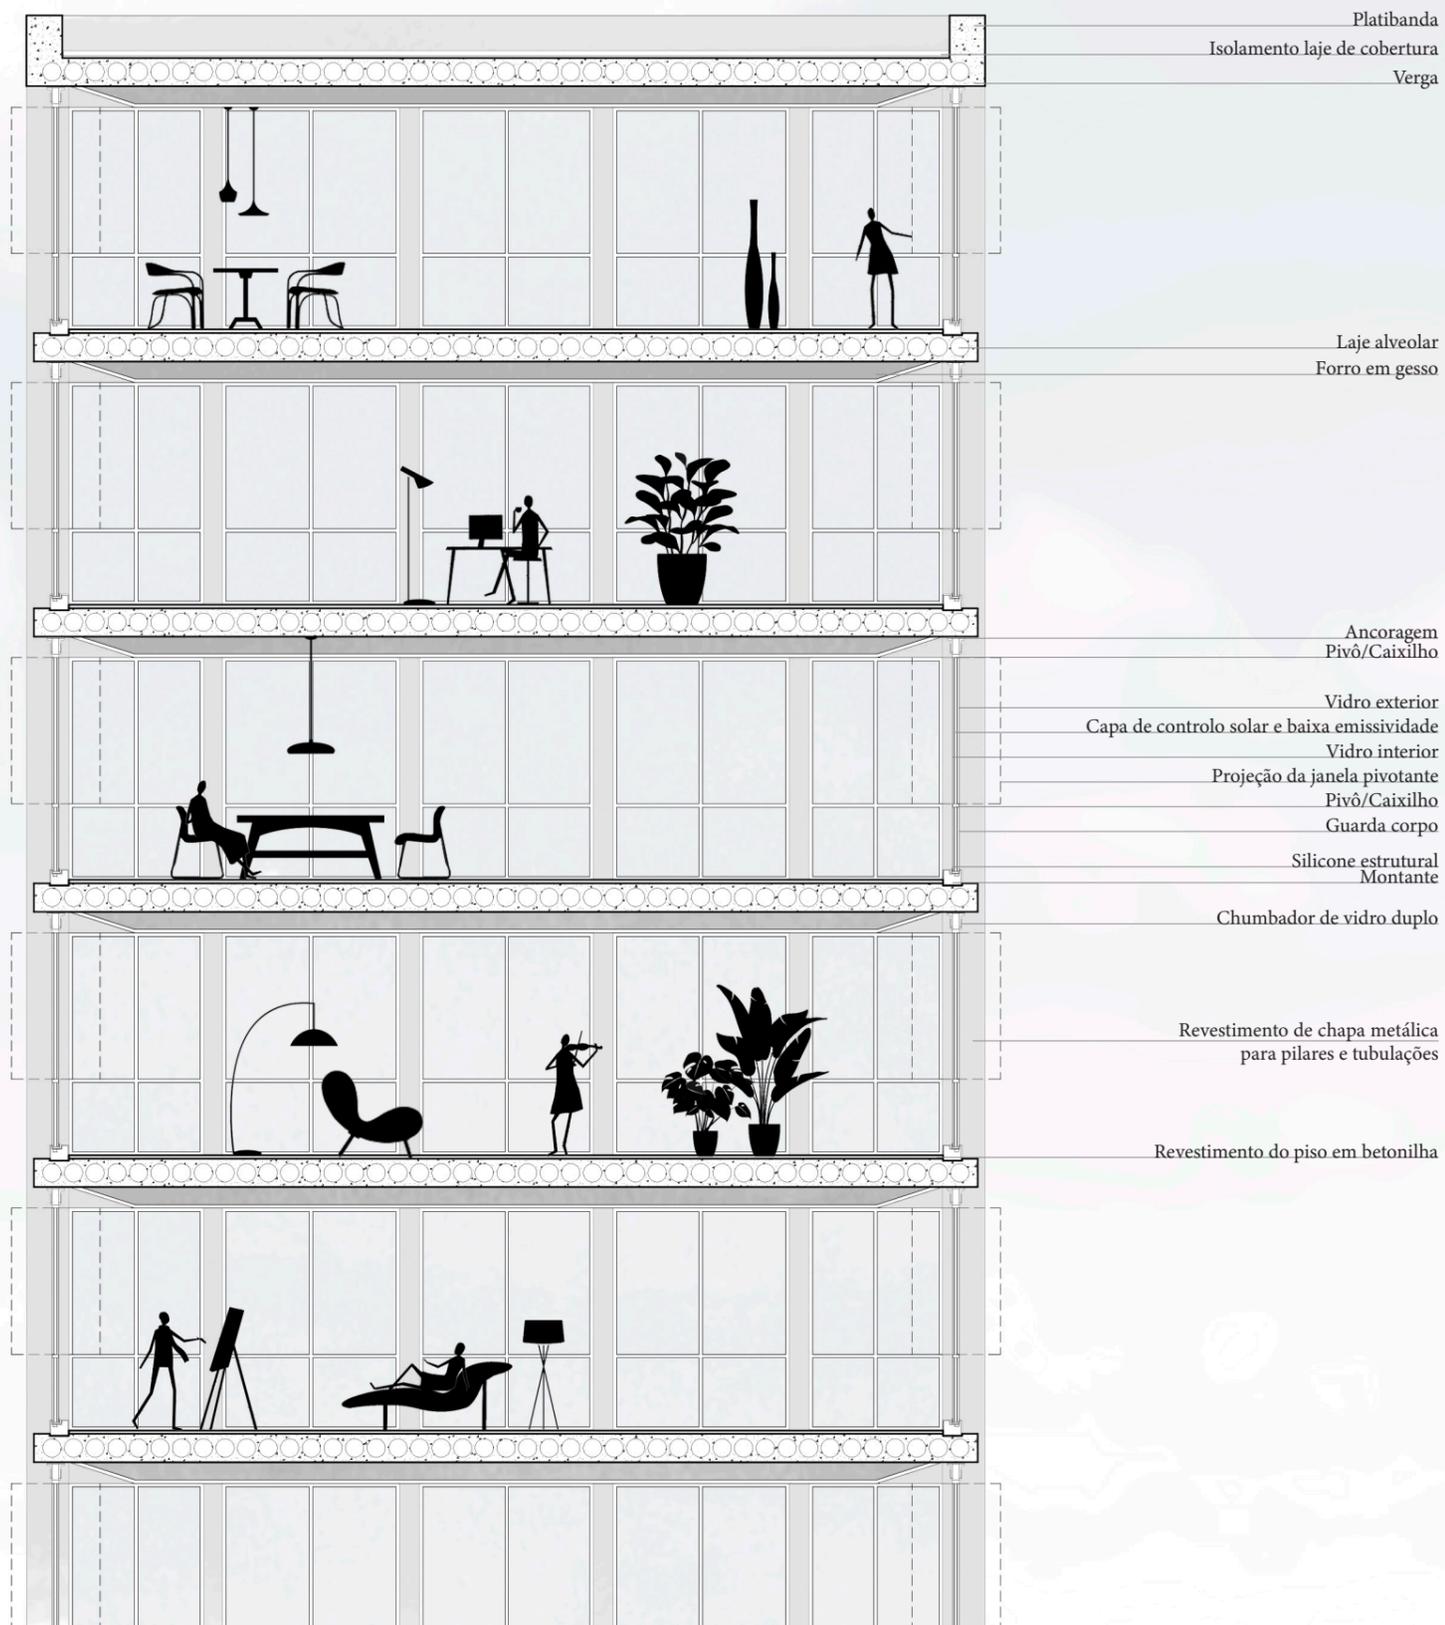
Corte estrutural de fachada. Escala 1:100.
